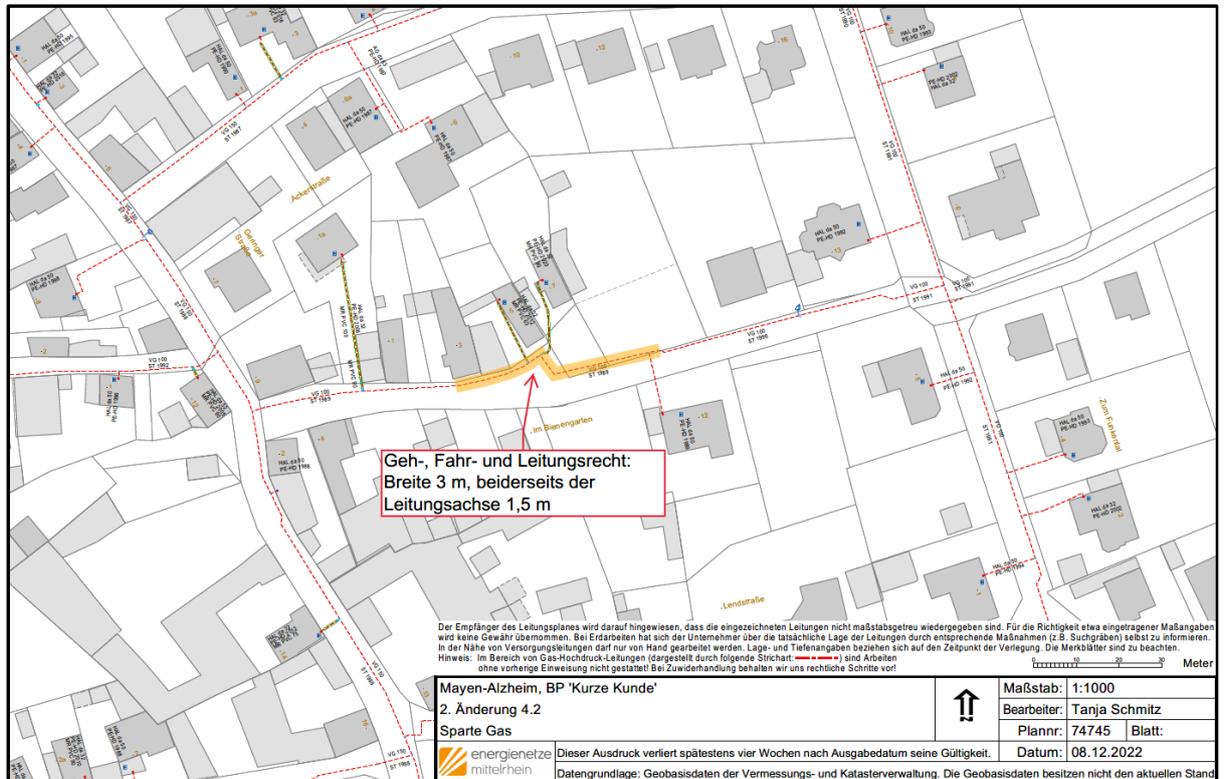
Lage der Gasleitung im Bereich des Bebauungsplans
